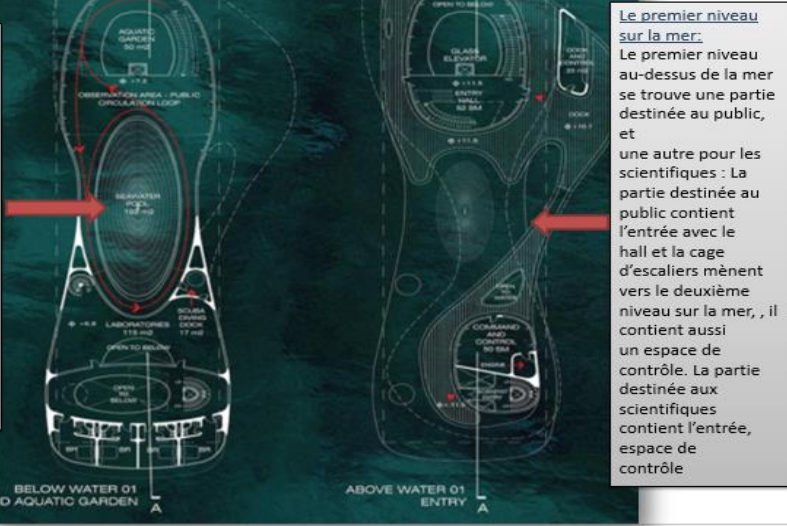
Plan du niveau 1 et 2 sous et sur la mer ; Source : Bali tangram 3D,2018
